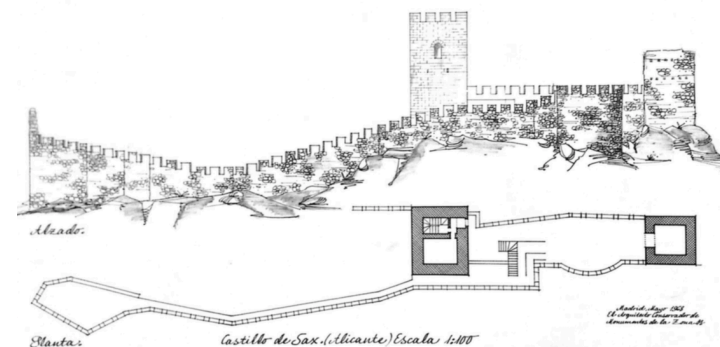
Planta y alzado de la reconstrucción del lienzo de muralla Sur realizada por Ferrant.
